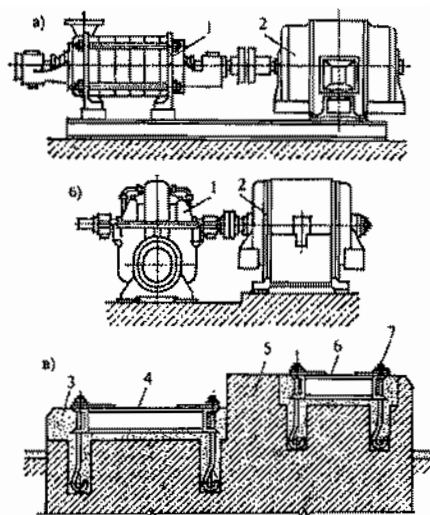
Установка горизонтальных насосов: 1 - насос; 2 - электродвигатель; 3 - монтажная подбетонка (подливка); 4 - рама под насос; 5 - фундамент; 6 - рама под электродвигатель; 7 - анкерный болт
